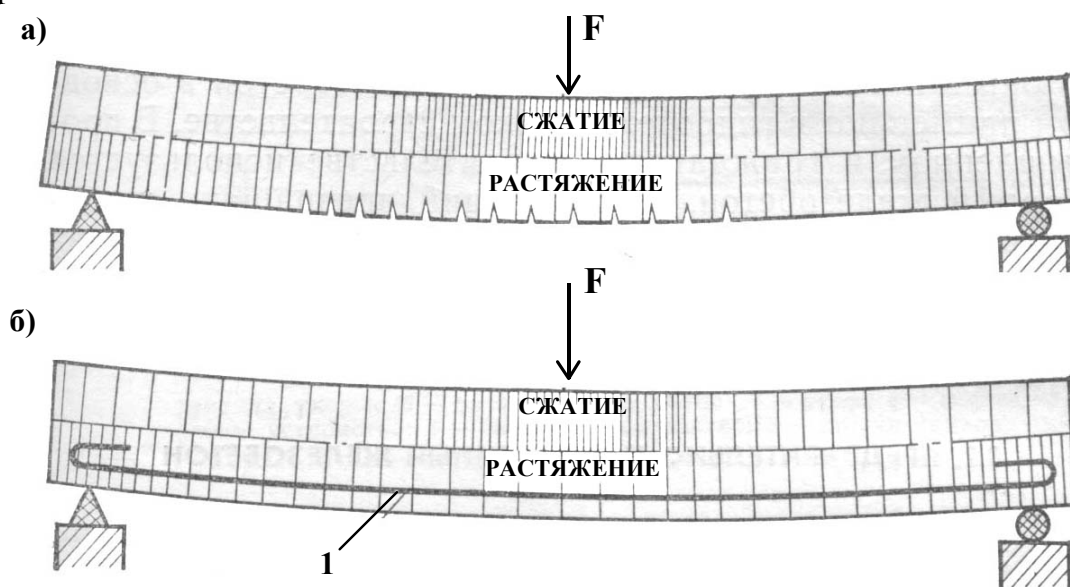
Неармированная бетонная (а) и армированная (б) балки:
